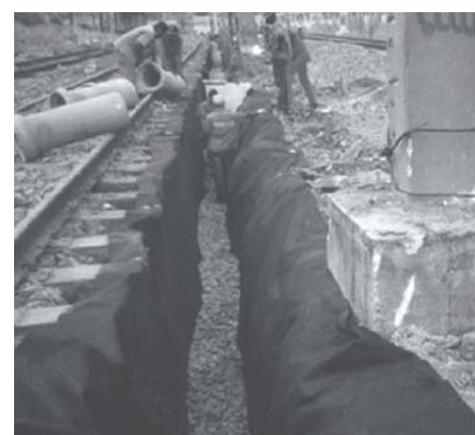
Dreno ao longo de uma ferrovia utilizando geotêxtil como elemento filtrante^[5].
